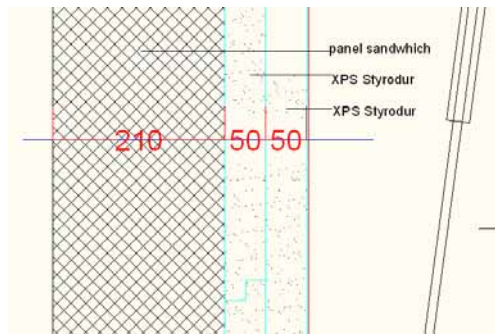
Figura 1 : Detalles de la sección en alzado de la fachada de calibración "as built"
